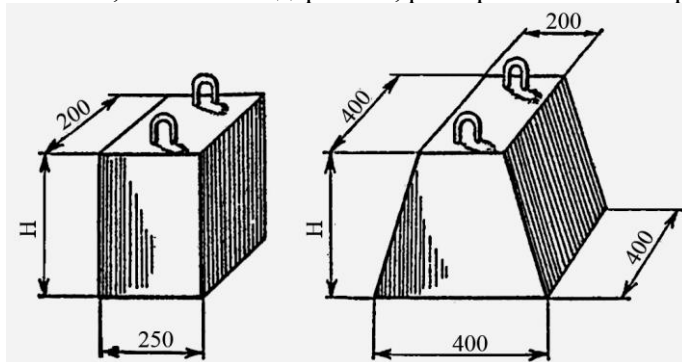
Типові форми й розміри залізобетонних тумб для підкладок під штабелі (H – висота тумби від 300 до 750 мм залежно від снігового покриття або глибини залягання ґрунтових вод)
